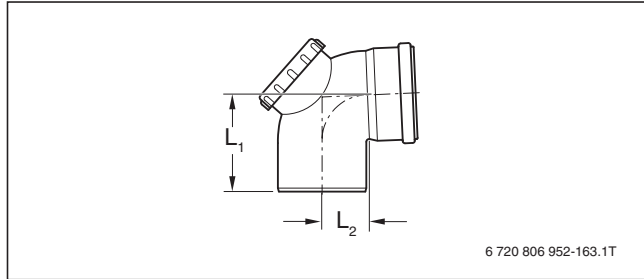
Bogen mit Prüföffnung GB225 (Maße in mm)
